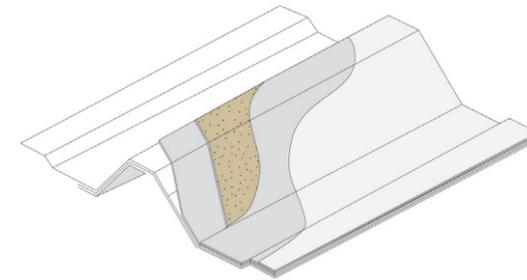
Recubrimiento de cubierta metálica tipo deck
